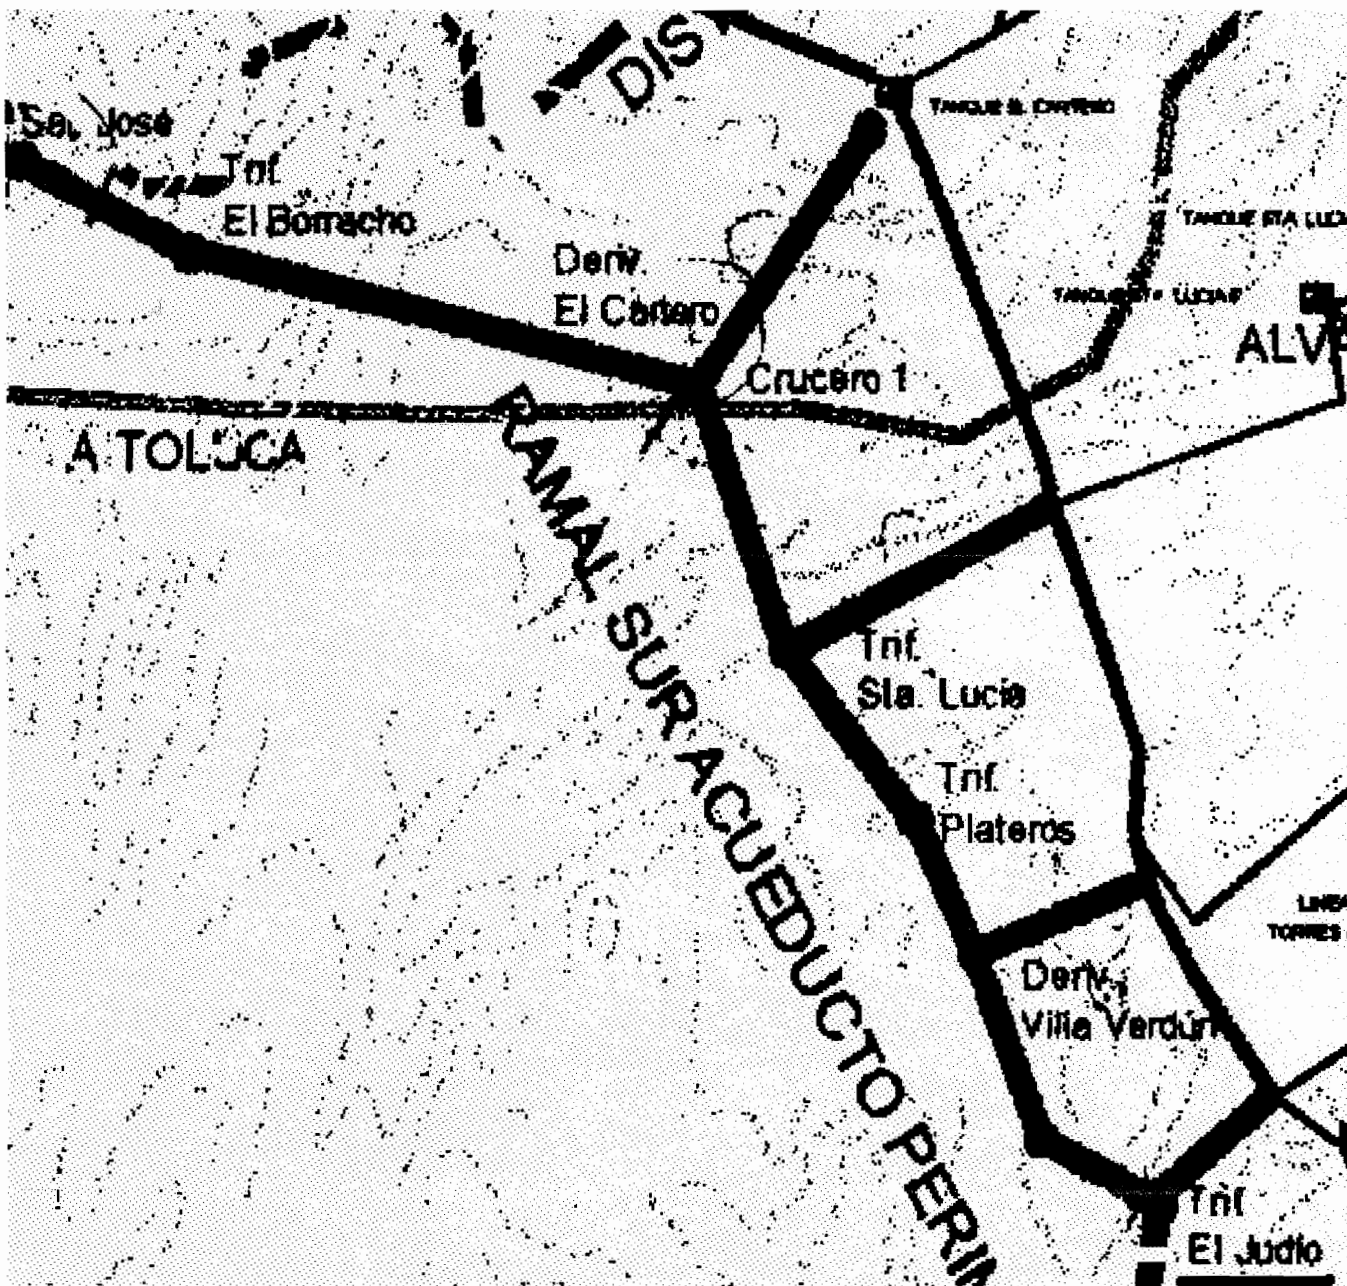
Planta y Perfil del Acuaférico
